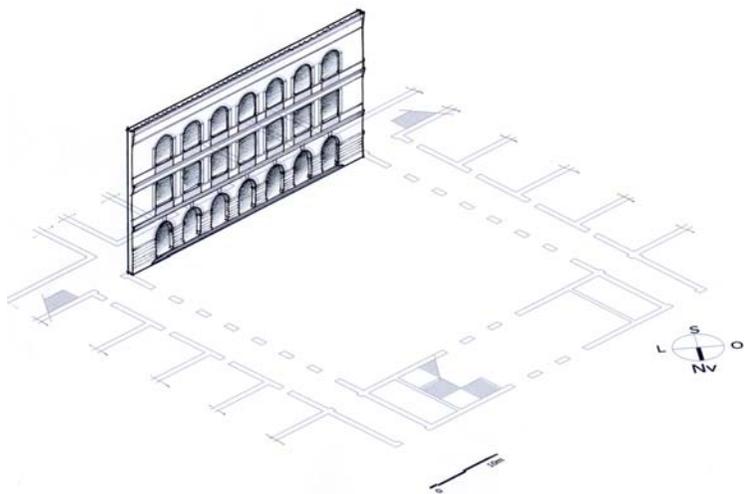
Estudo dos planos verticais, fachada Sudeste do pátio interno do ISE RJ.
